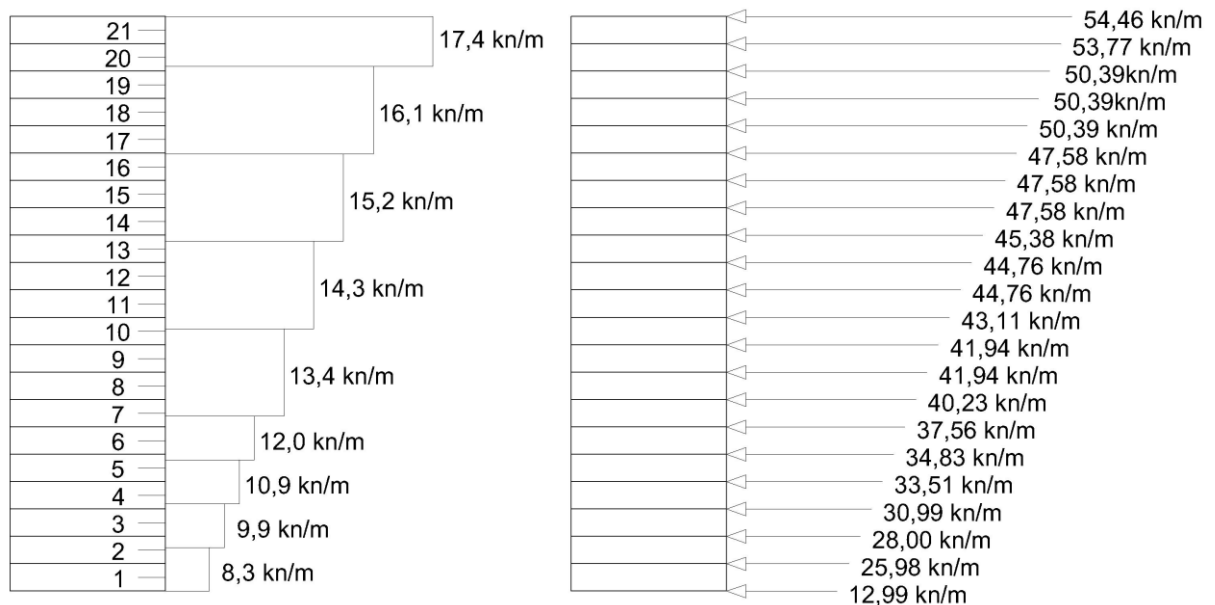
Cargas de vento distribuídas para cada pano de laje na fachada menor.
